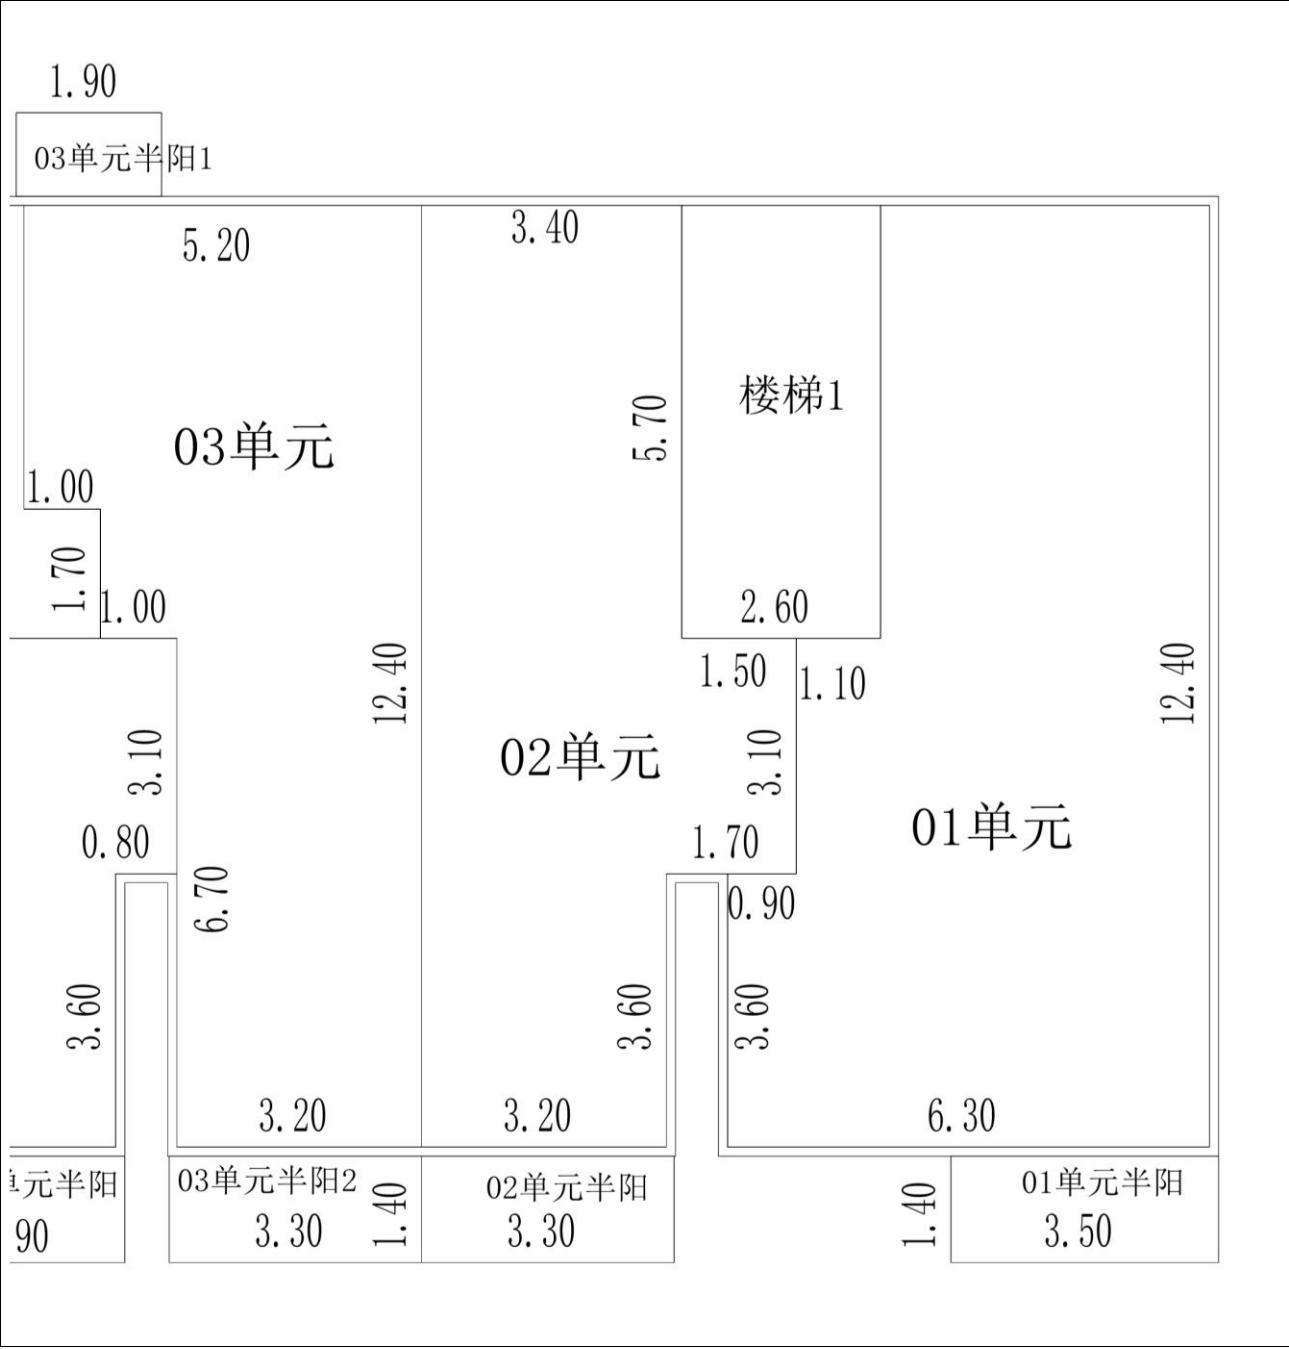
房屋分层分户平面图样示 2 局部放大图
